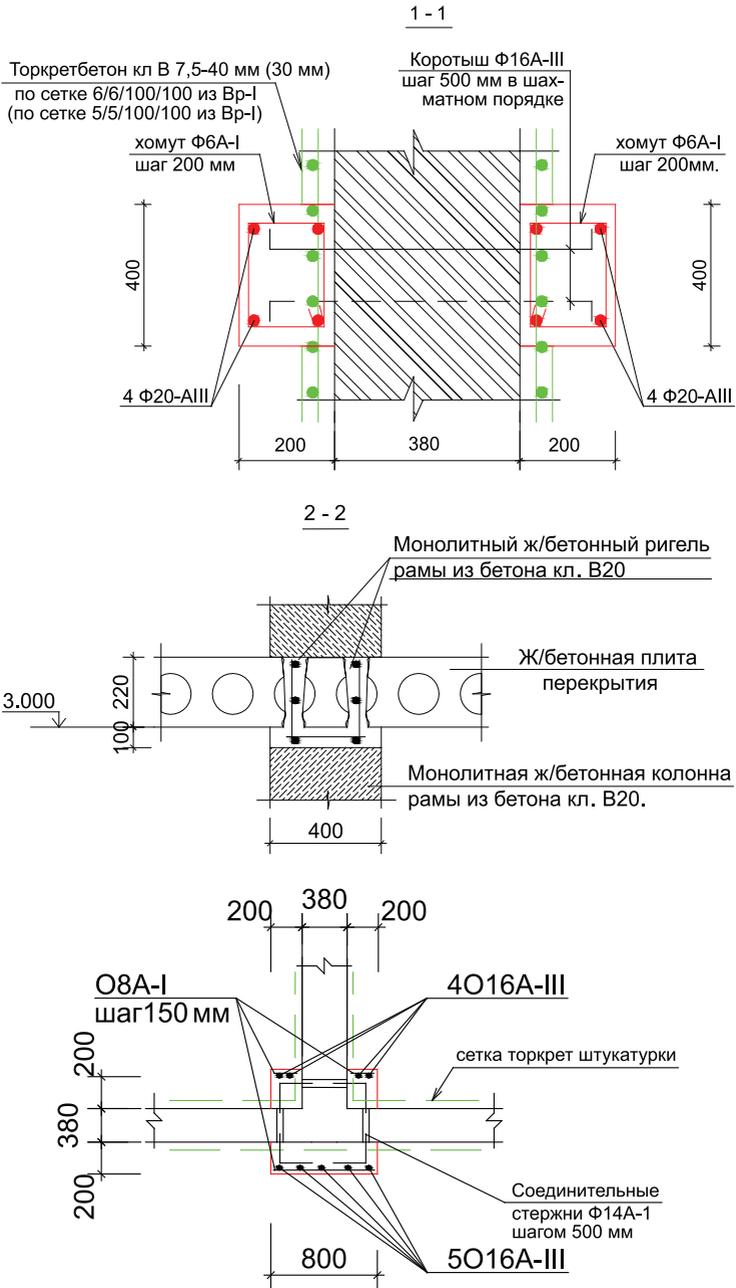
Схема усиления здания с продольными несущими стенами монолитным железобетоном
